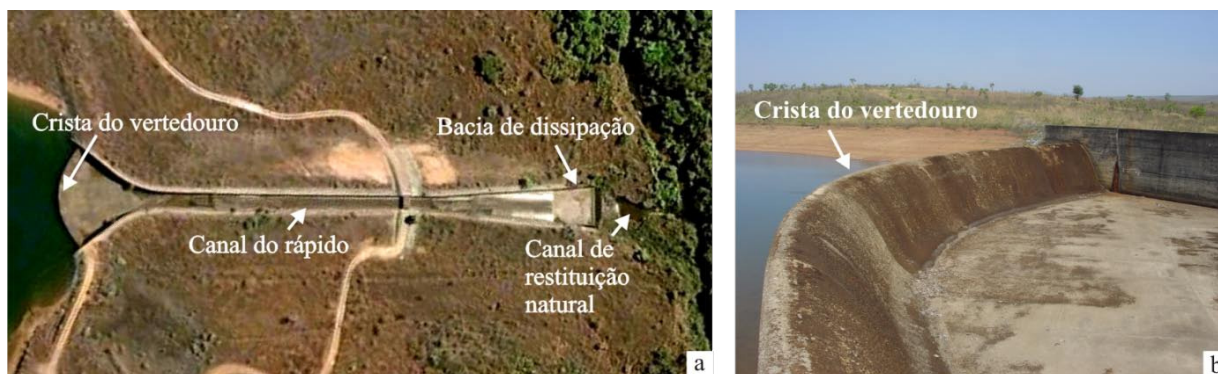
Estrutura responsável pela descarga das vazões excedentes da barragem de Santa Maria: a) foto do conjunto: vertedouro, rápido e bacia de dissipação; b) detalhe do vertedouro em leque com seção do tipo Creager.
